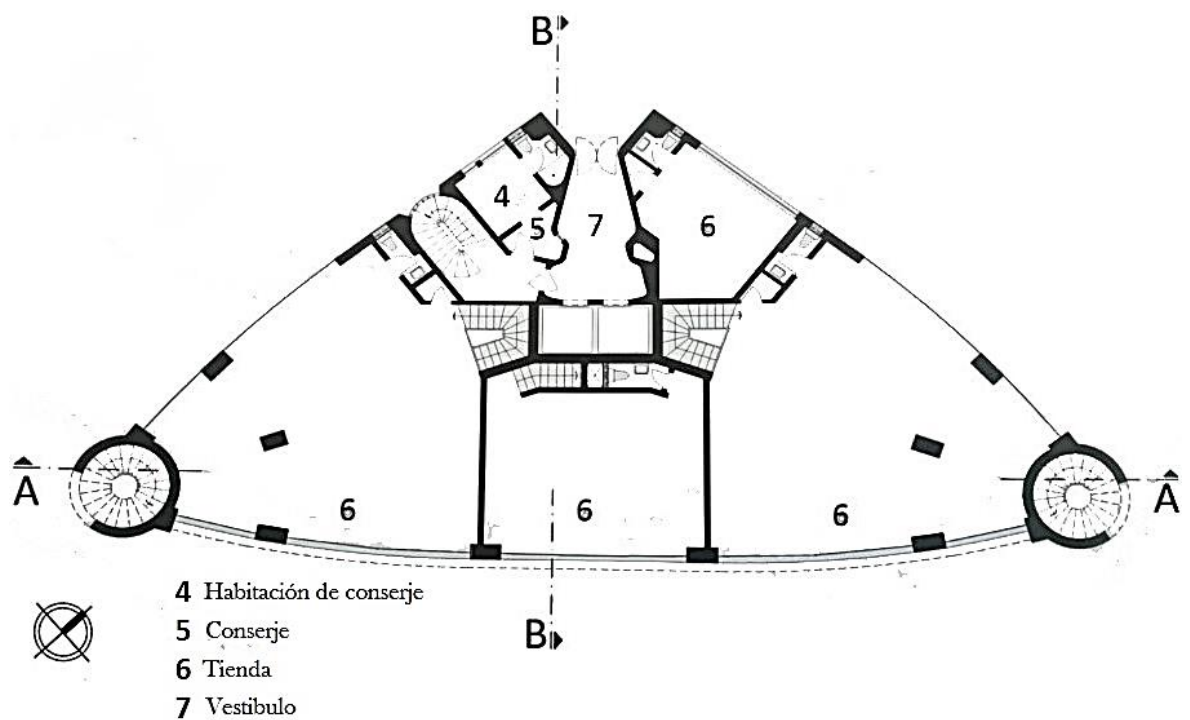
Planta del 1º nivel. Planta elaborada por Viccina (2015).
